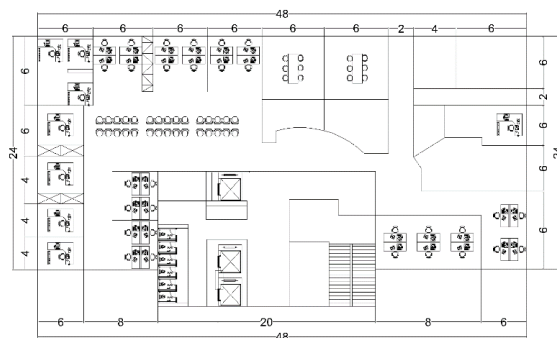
Denah Gedung UOB Plaza M.H Thamrin
